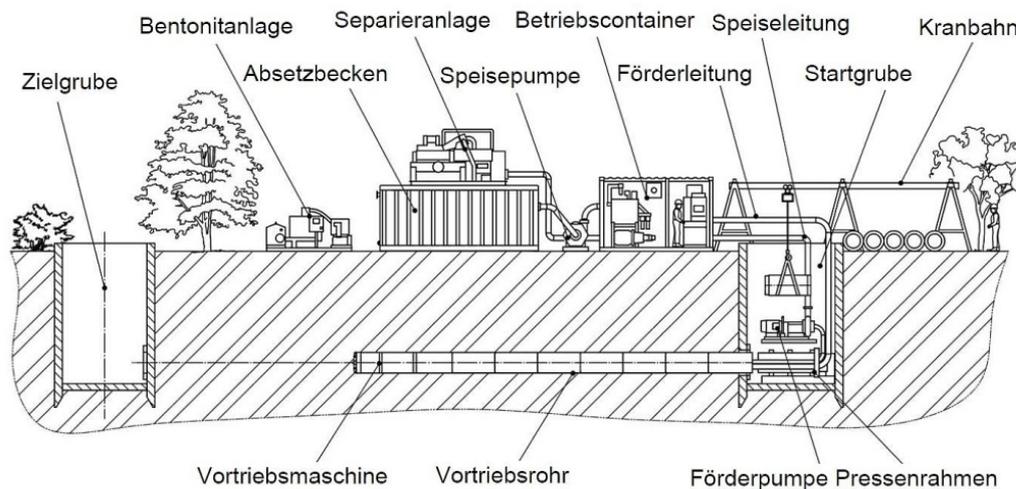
Beispiel Mikrotunnelbau mit Spülförderung, Quelle: DWA 2008
